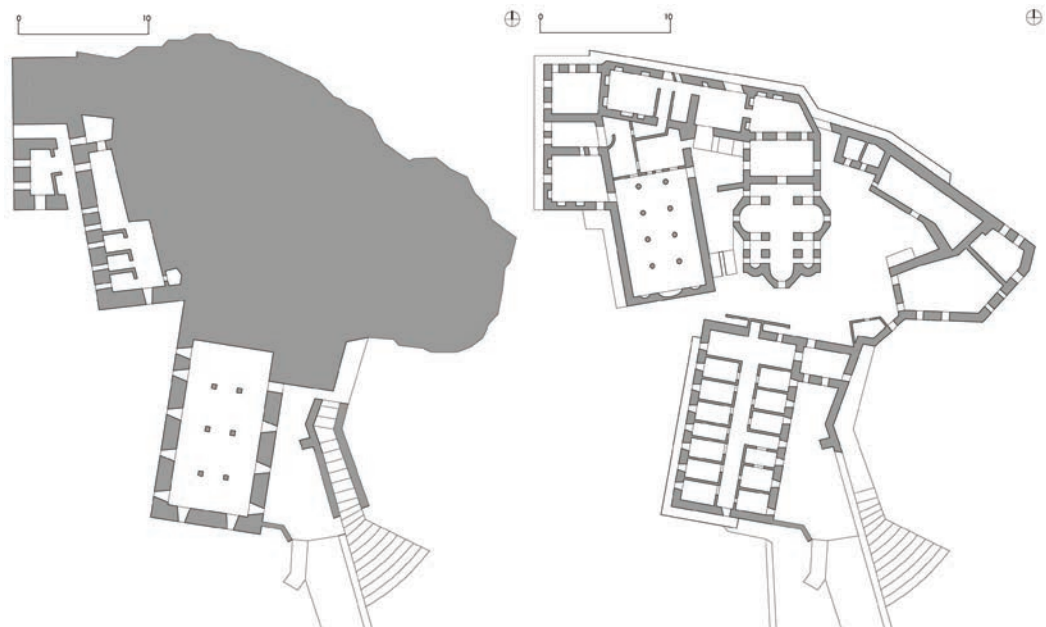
Il Monastero di Simonpetra. Planimetria piano ipogeo.
